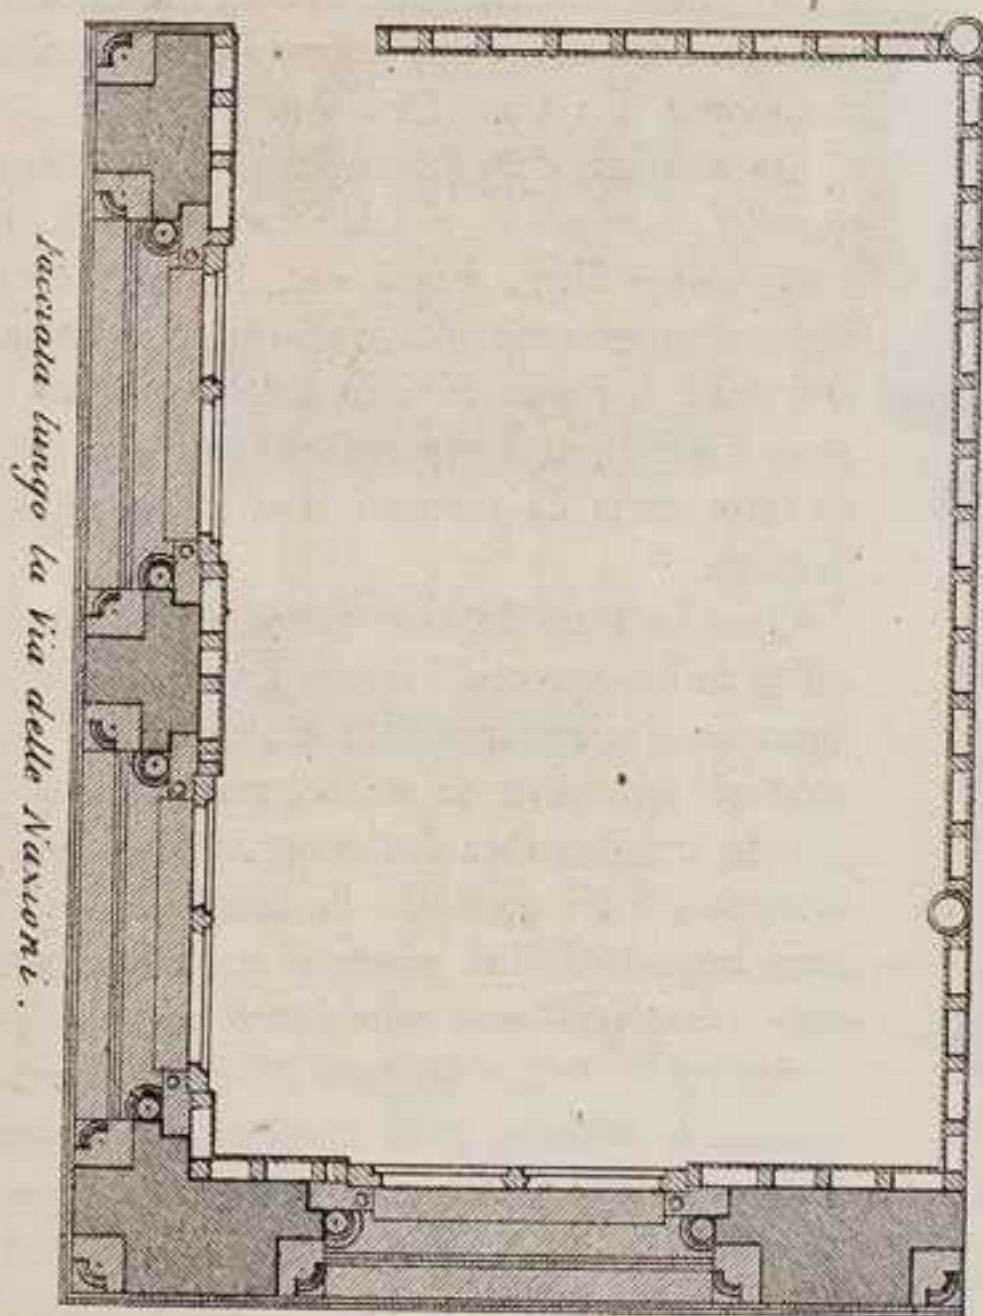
Pianta dell'edificio dei signori Doulton. Scala di 0<sup>m</sup> 014 p. metro.
